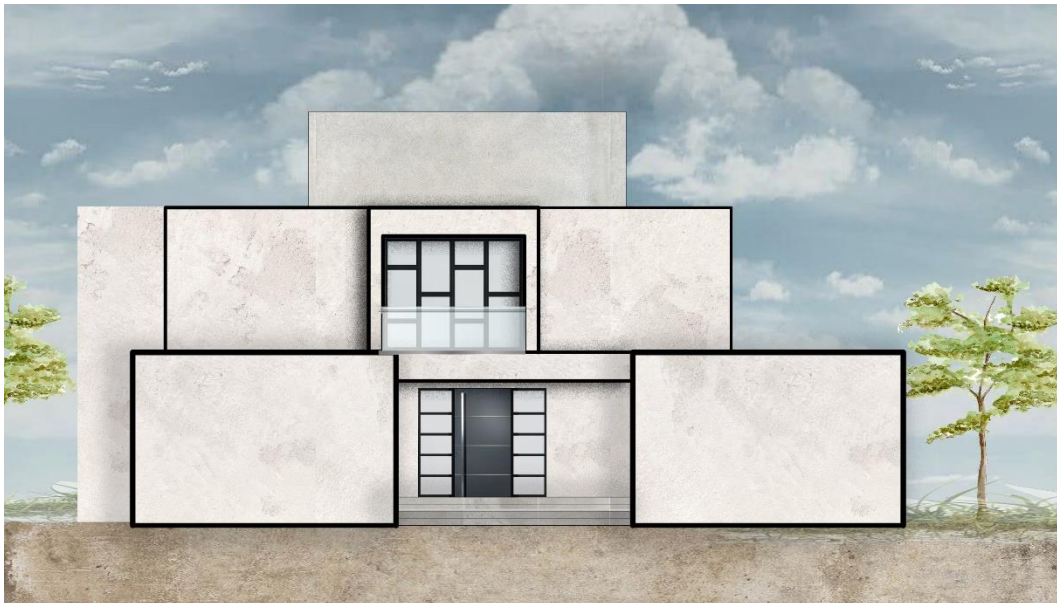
Façade ouest des villas individuelle, Elaborée par : Auteurs, 2025
